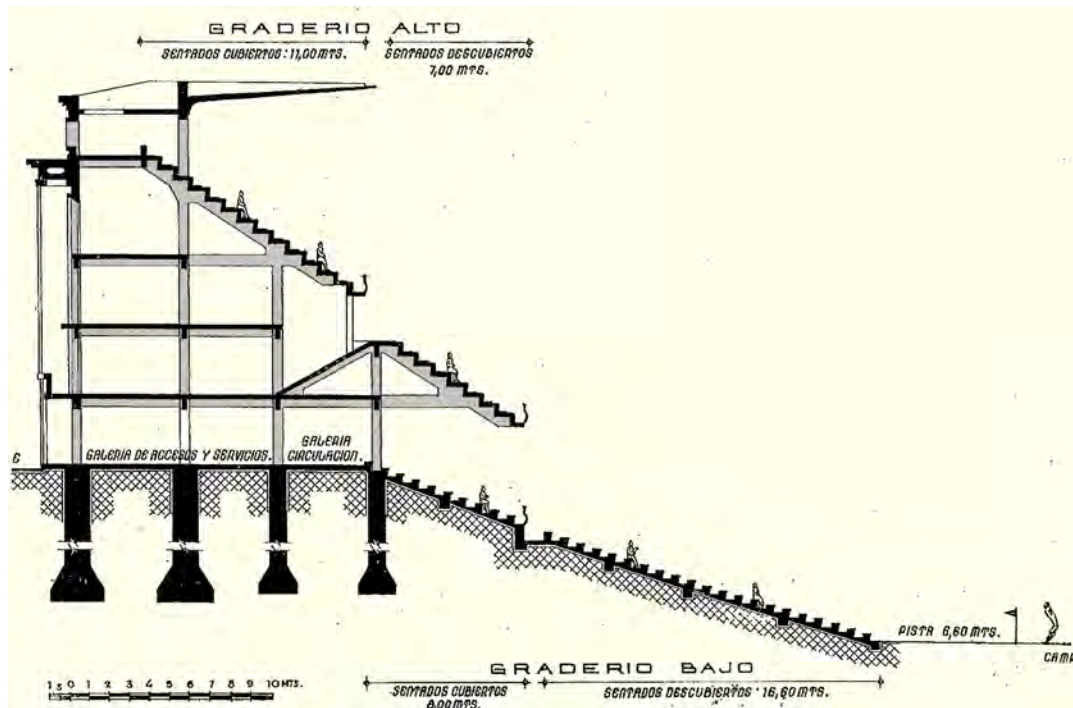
Sección transversal tipo en el lateral oeste del estadio original (1944-1947). La visera superior, de 10 m de vuelo, no fue construida.
